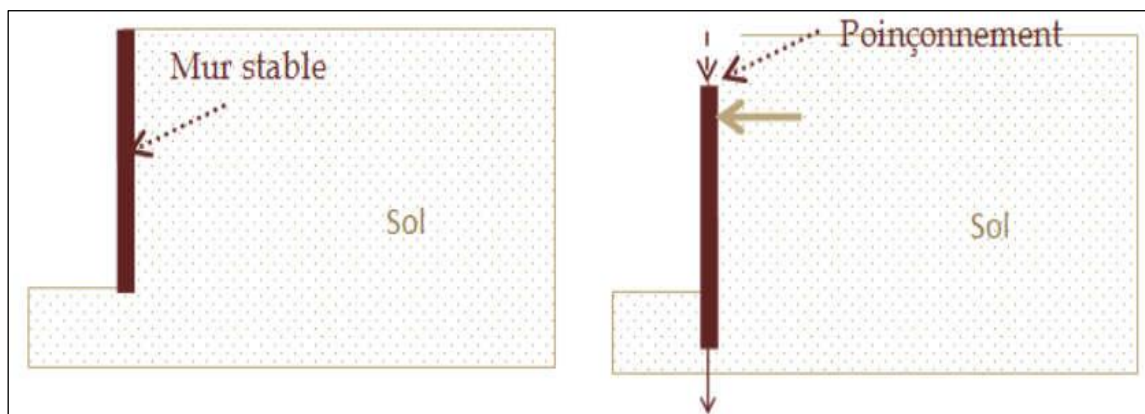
Instabilité externe d'un mur par poinçonnement du sol de fondation
